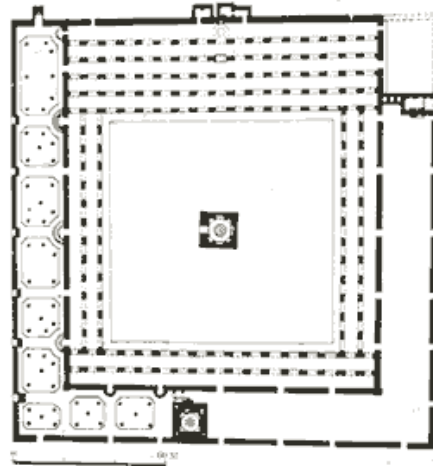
١ - مسقط أفقي لمسجد عمرو بن العاص - القاهرة.
